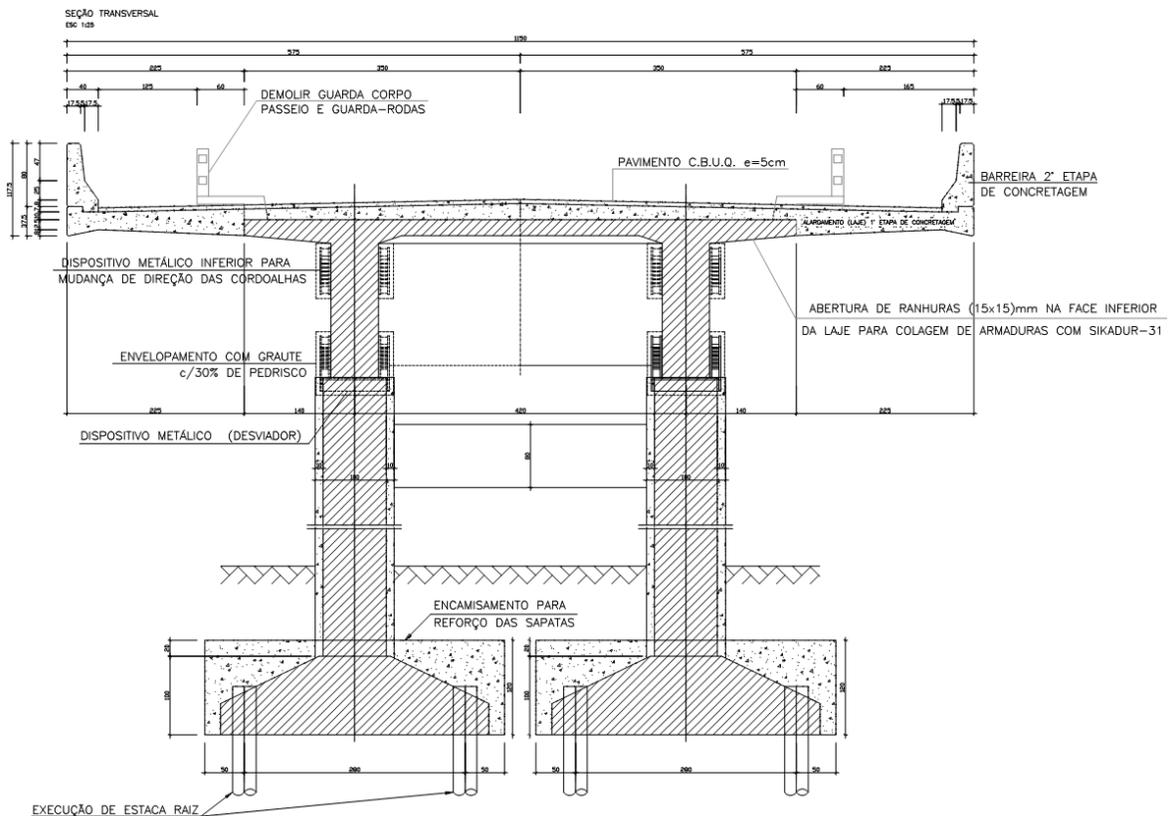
Reforço das fundações diretas existentes com a utilização de estacas raiz e encamisamento das sapatas existentes (VITÓRIO. (2014)).
